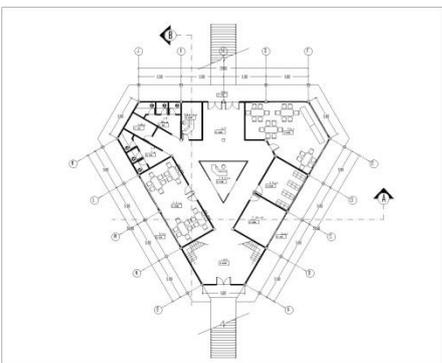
Denah Lantai 1 Ged. E (Guest House)
